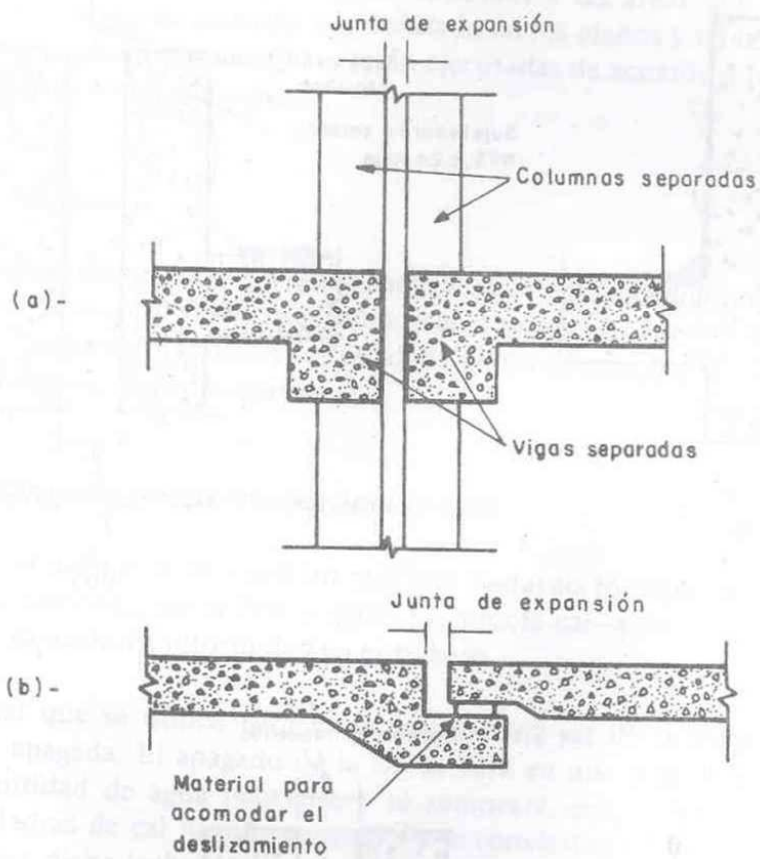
Juntas de Expansión (a) Juntas con vigas y columnas separadas; y (b) Juntas en las losas a $1/3$ ó $1/4$ del tramo. —
